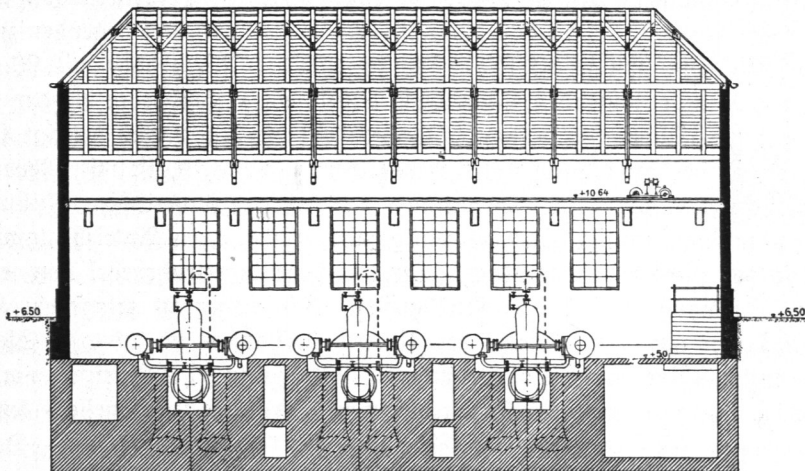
Pumpwerk Allermöhe, Längenschnitt durch das Maschinenhaus.
